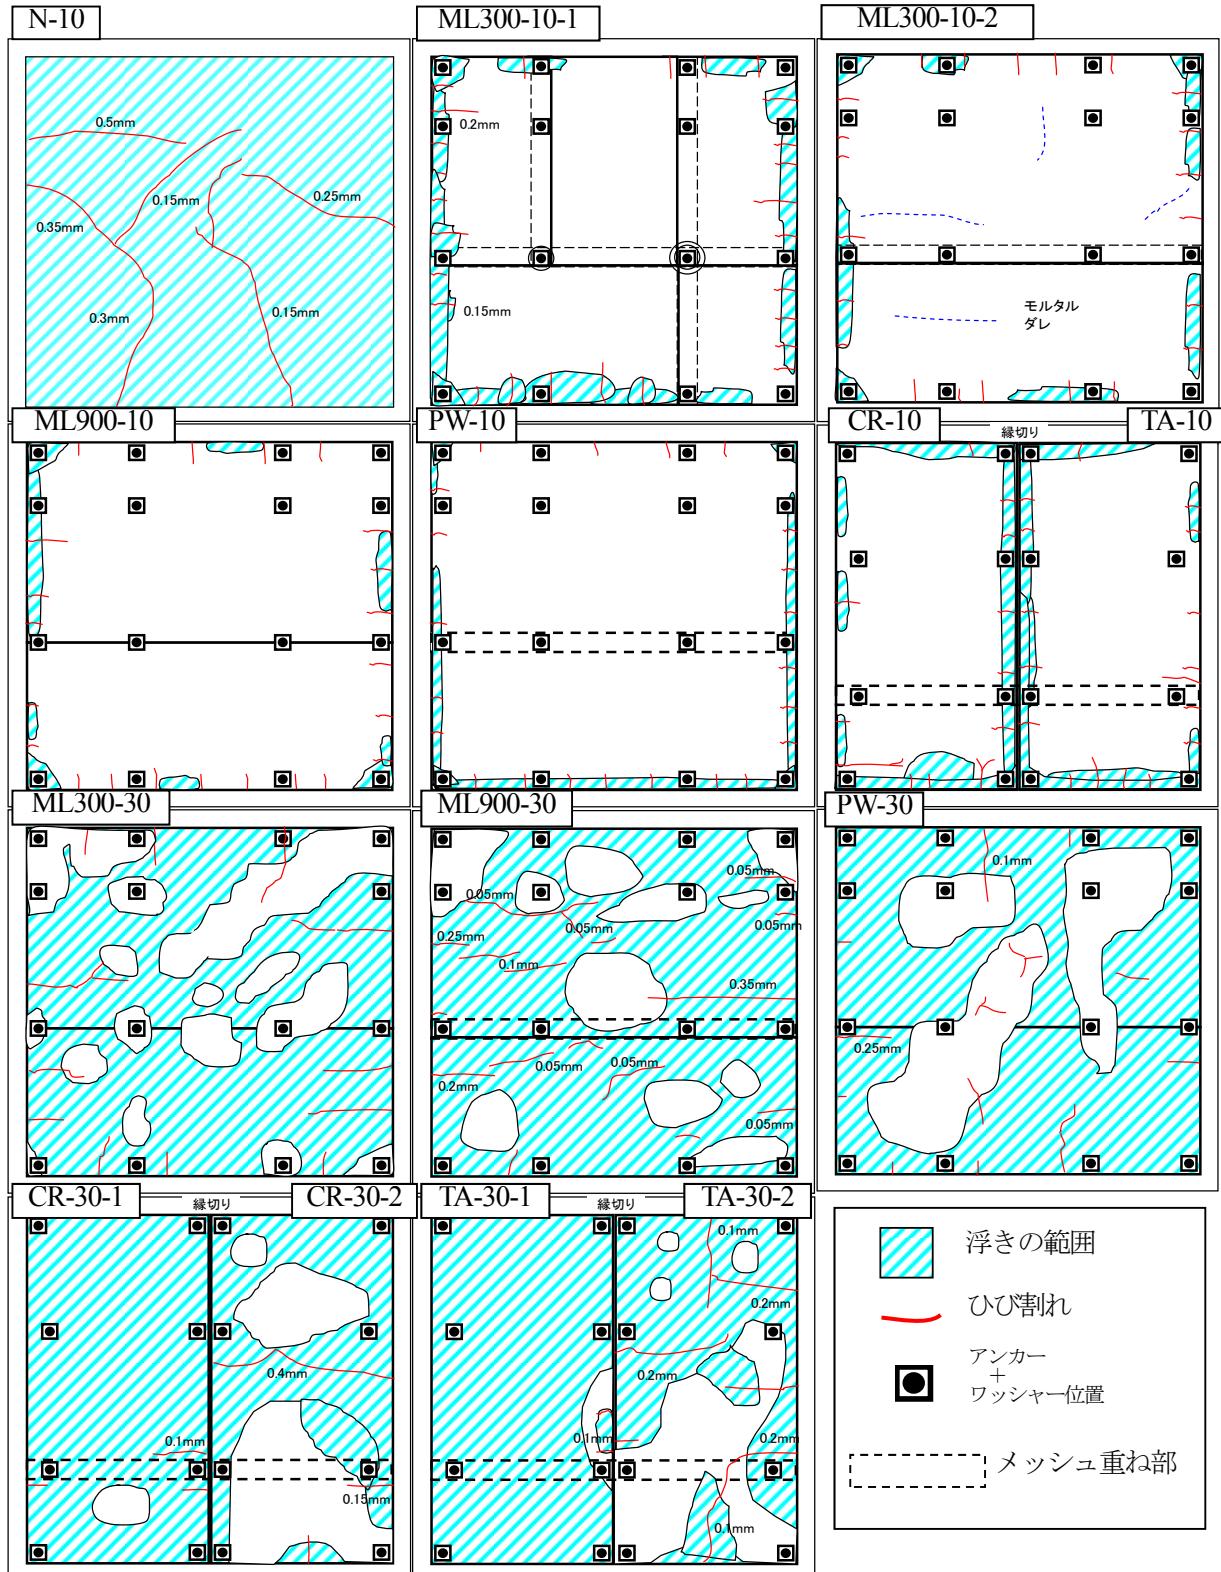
試験体の浮き・ひび割れ発生状況（加熱前）
